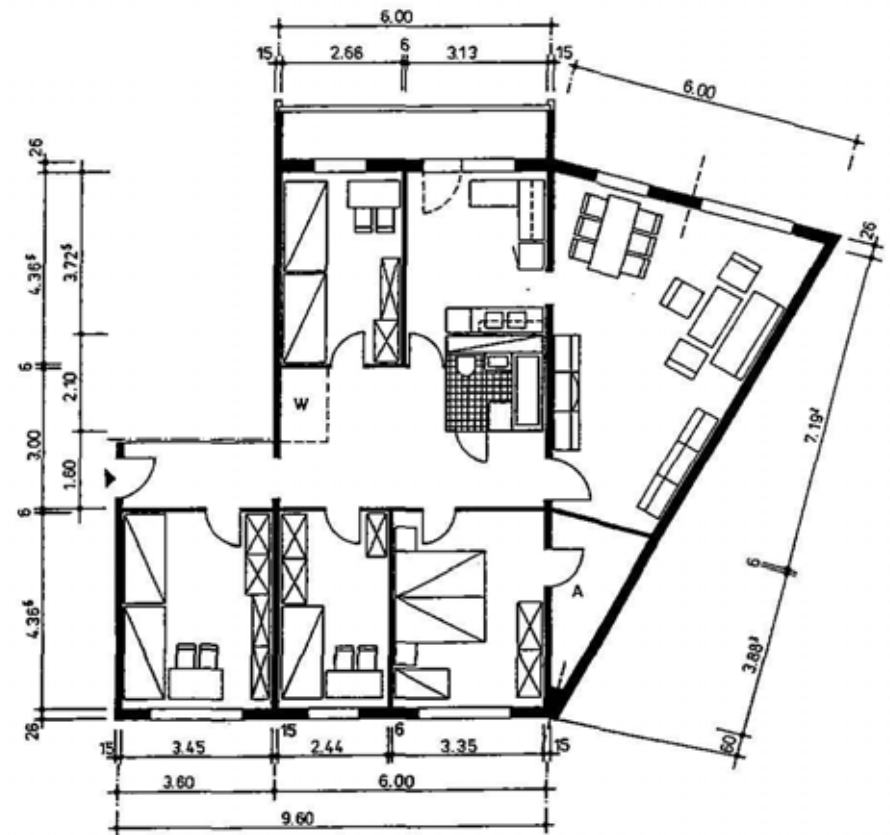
Grundriß einer 4-Raumwohnung
